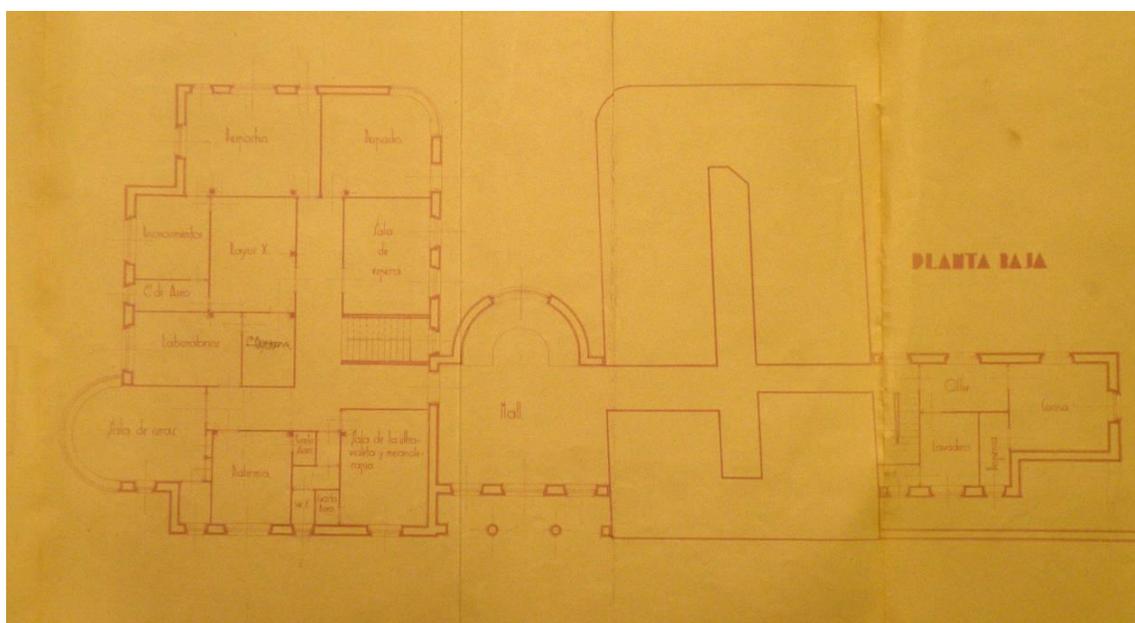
Clínica de don Dacio Crespo. Plano de planta baja. Proyecto arquitectónico, julio de 1933, AHPZa, AMZa, OyU. 751/49.
